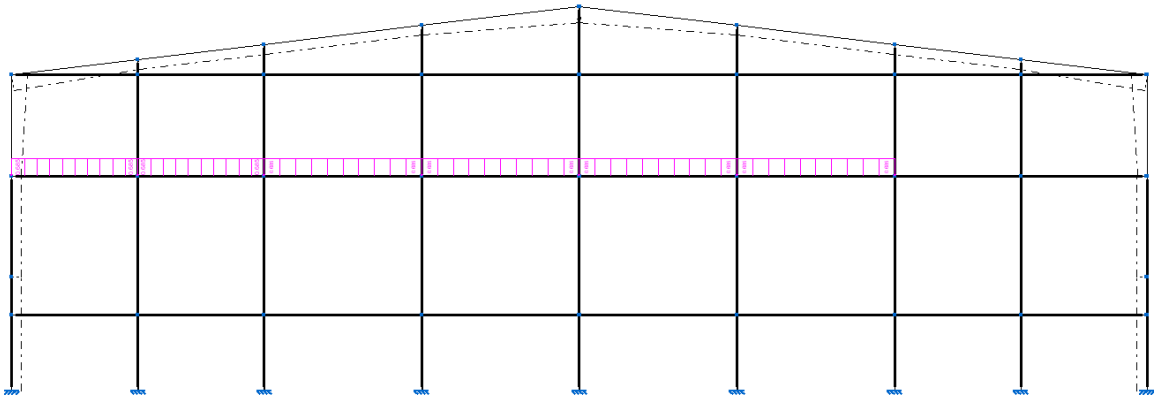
Carga cubierta gimnasio sobre pórtico posterior ($h=8,50m$)
